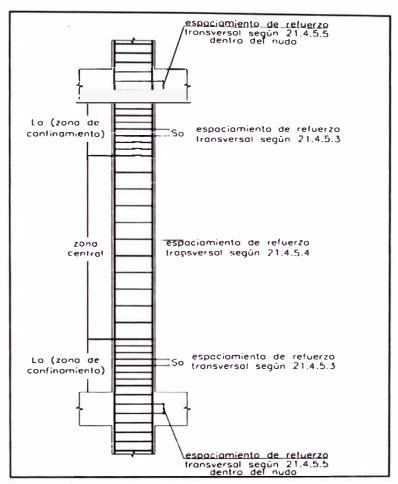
Requerimiento de estribos en columnas según Capitulo 21 de la Norma E.060
